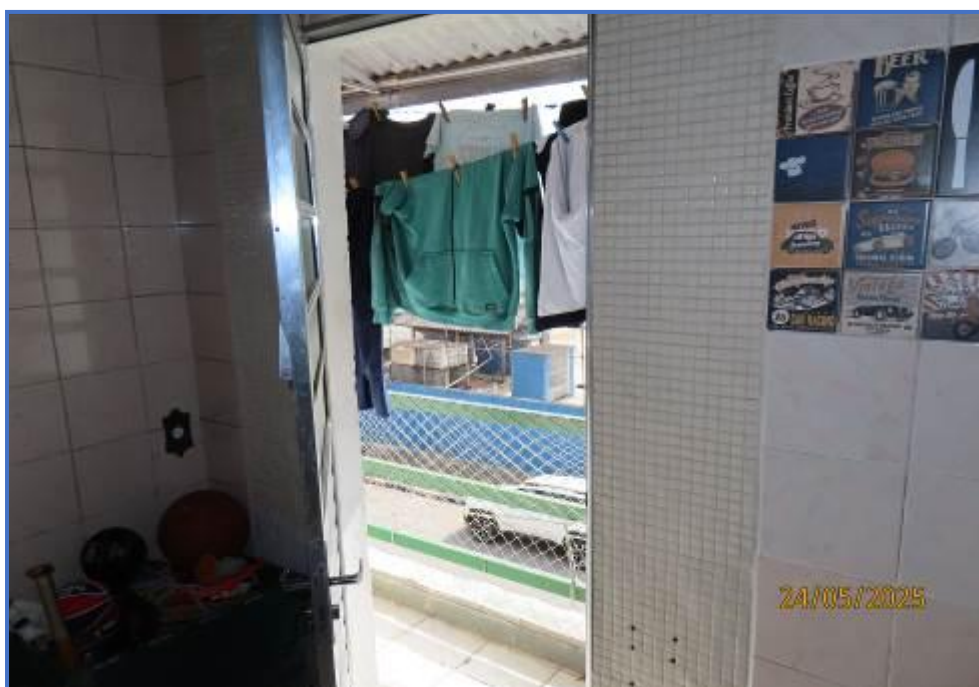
Vista do acesso a sacada no 2º pavimento.
